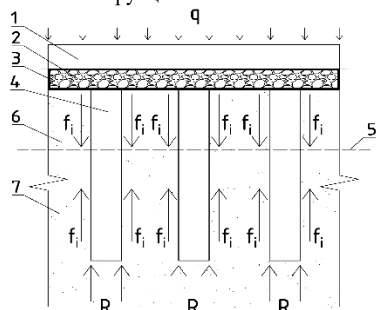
Расчетная схема работы изолированного свайно-ростверкового фундамента
